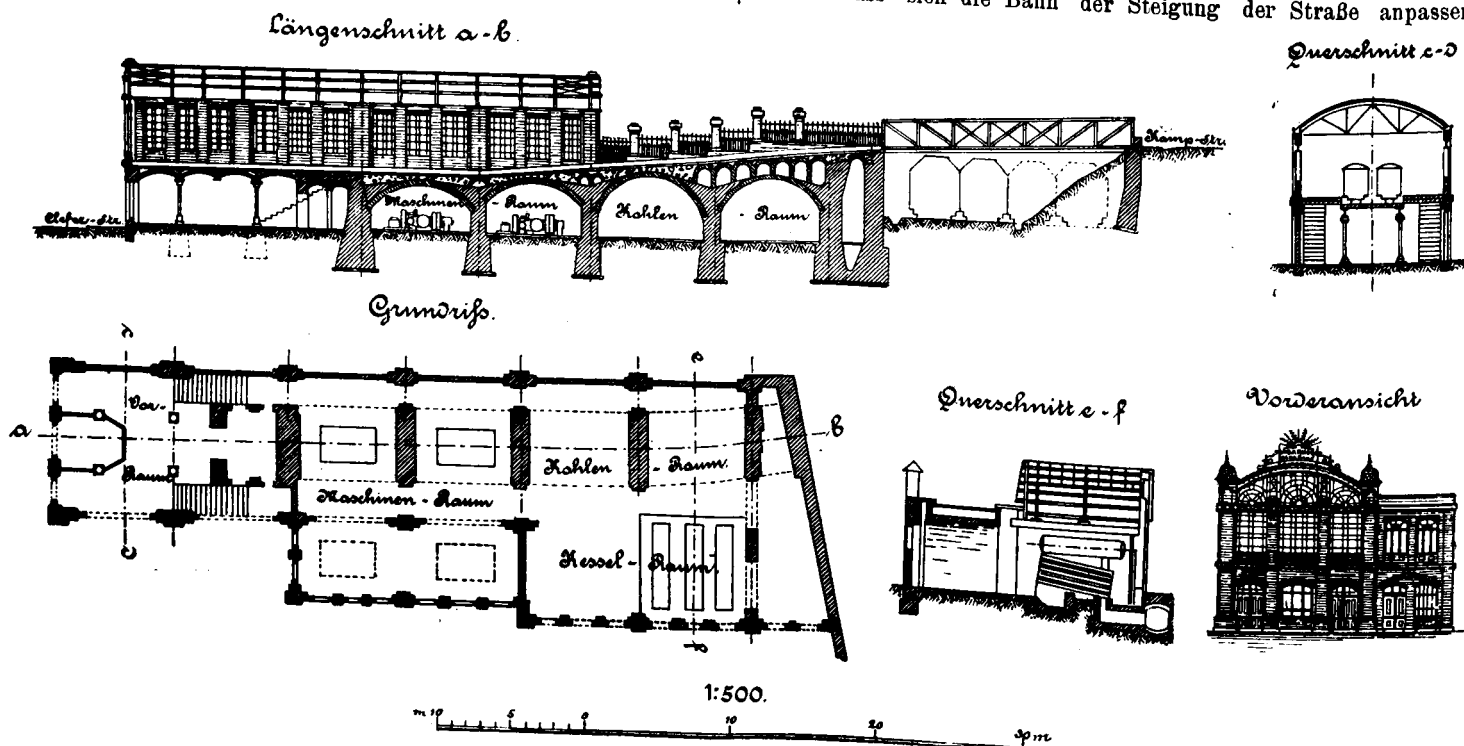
Längenschnitt und Grundriss des unteren Bahnhofes.
